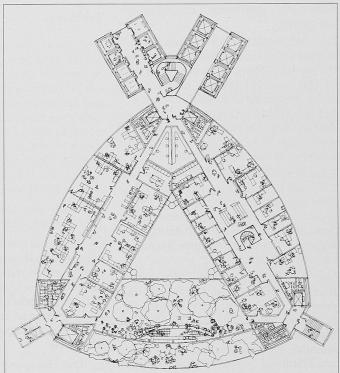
Projekt für die Commerzbank Frankfurt a. M. von Foster Ass. im Grundriss. Ein Atrium bildet den Kern des dreieckigen Hochhauses, in dem sich in jeder 3. Etage Gärten öffnen
